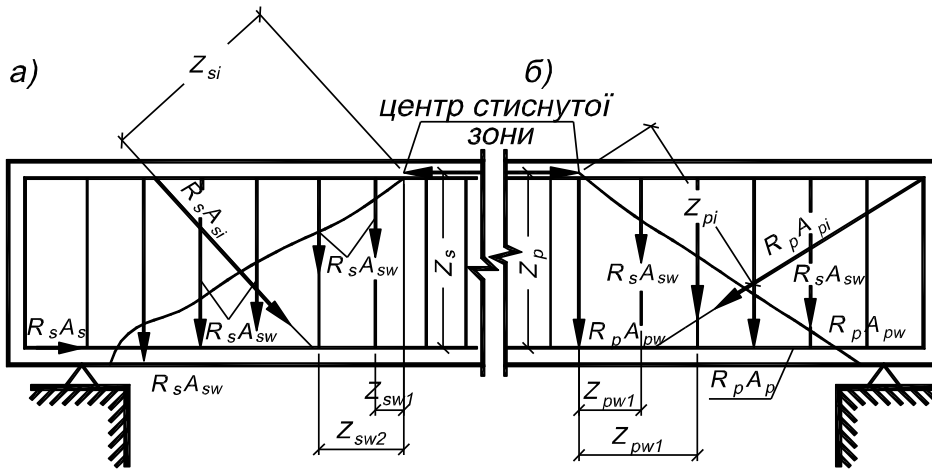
Схема зусиль у перерізі, нахиленому до поздовжньої осі залізобетонного елемента, при розрахунку його міцності на дію згинального моменту
